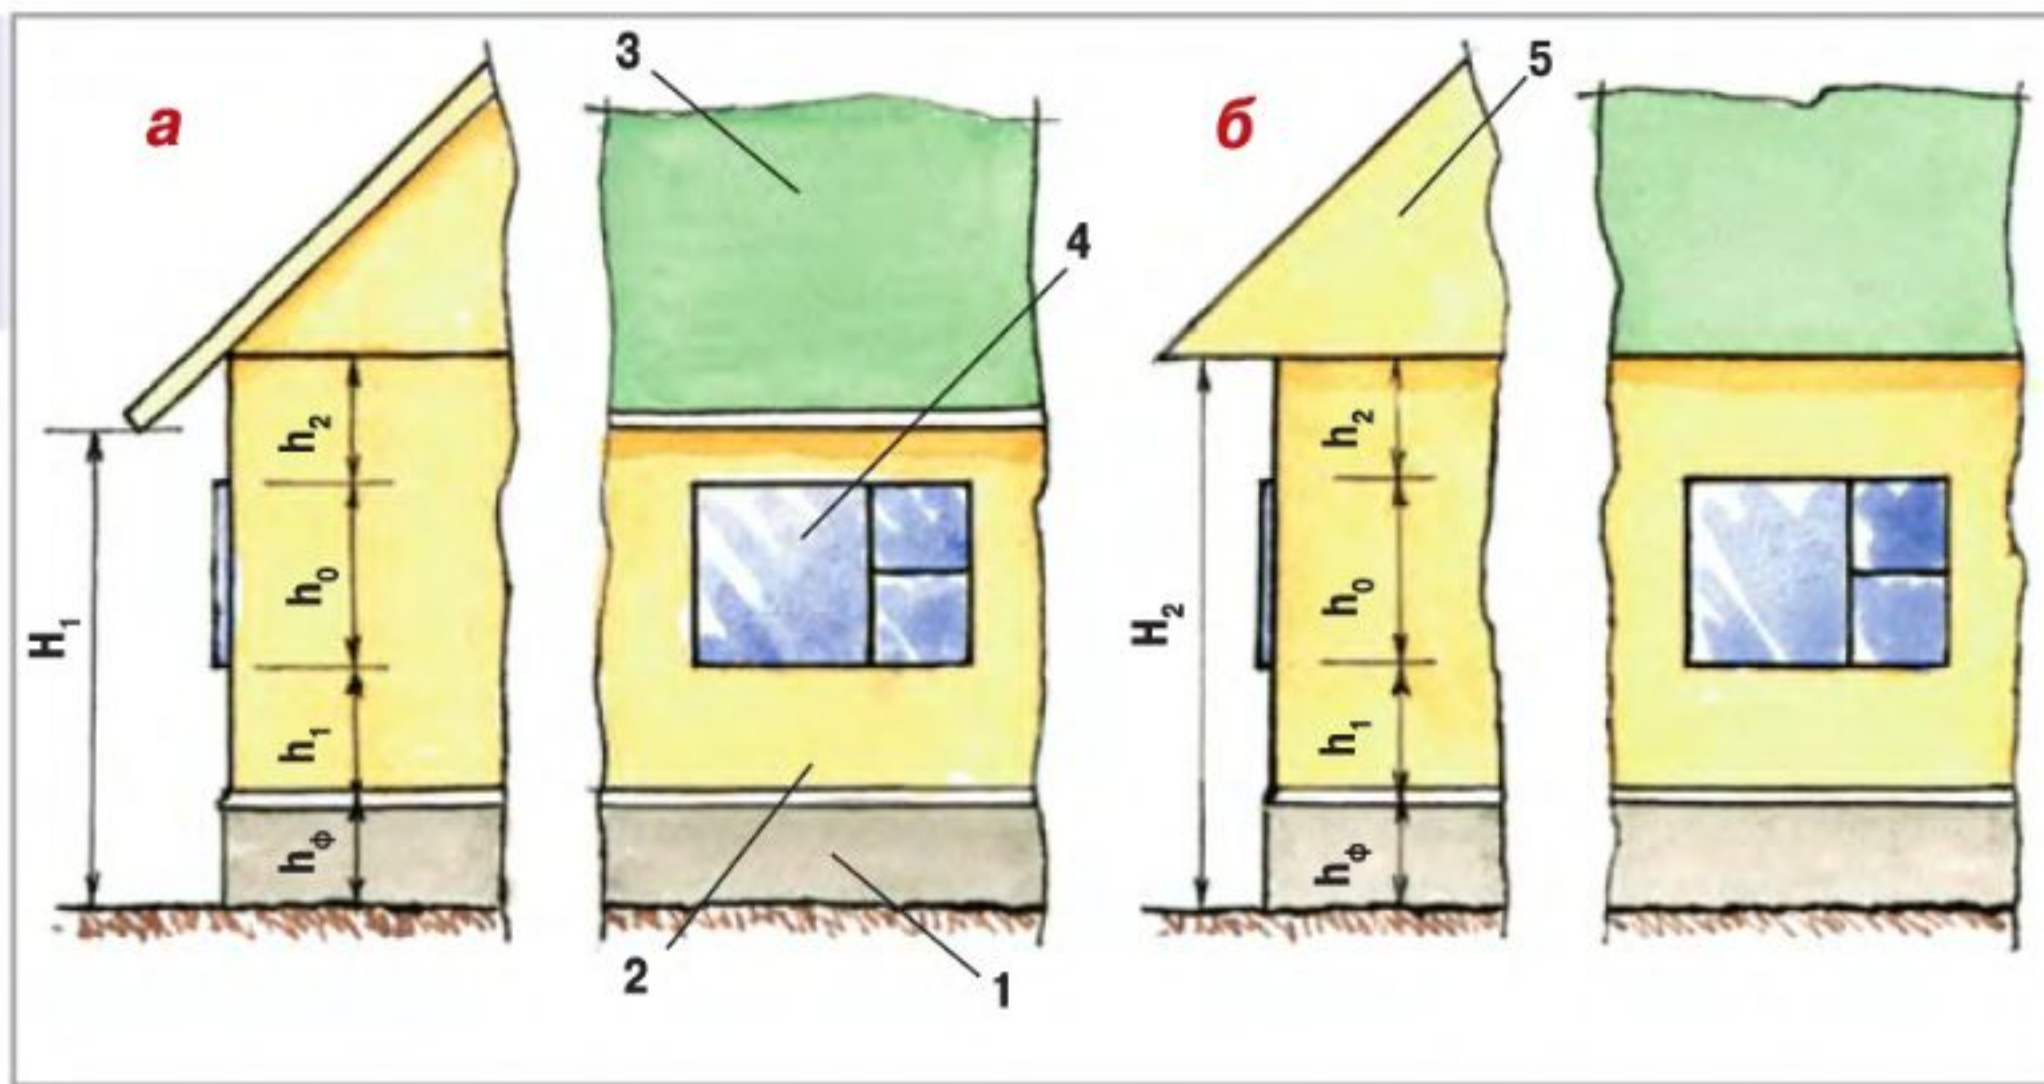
Схема взаимосвязей высоты стены и размеров окон для различных типов крыш: а — крыша с наслонными стропилами; б — крыша с висячими стропилами; 1 — фундамент; 2 — стена; 3 — скат крыши; 4 — окно; 5 — фронтон.
